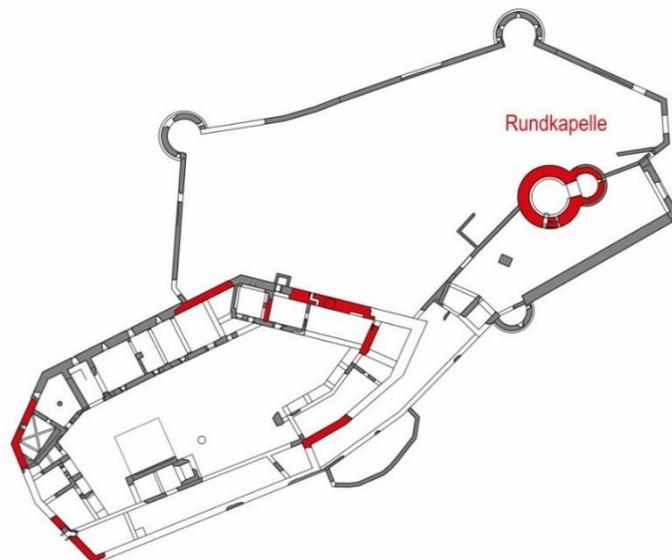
Burgruine Starhemberg, Grundriss der Burganlage (Baualterplan 12. Jh., Ronald WOLDRON)
